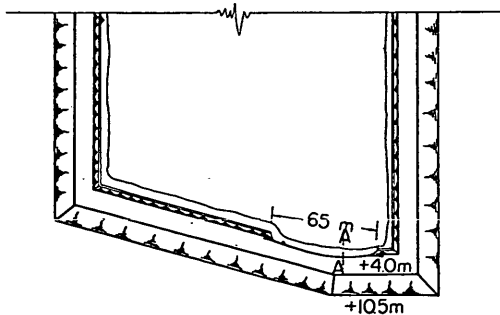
苫小牧港石油配分基地護岸 (g-1) 被災平面図
